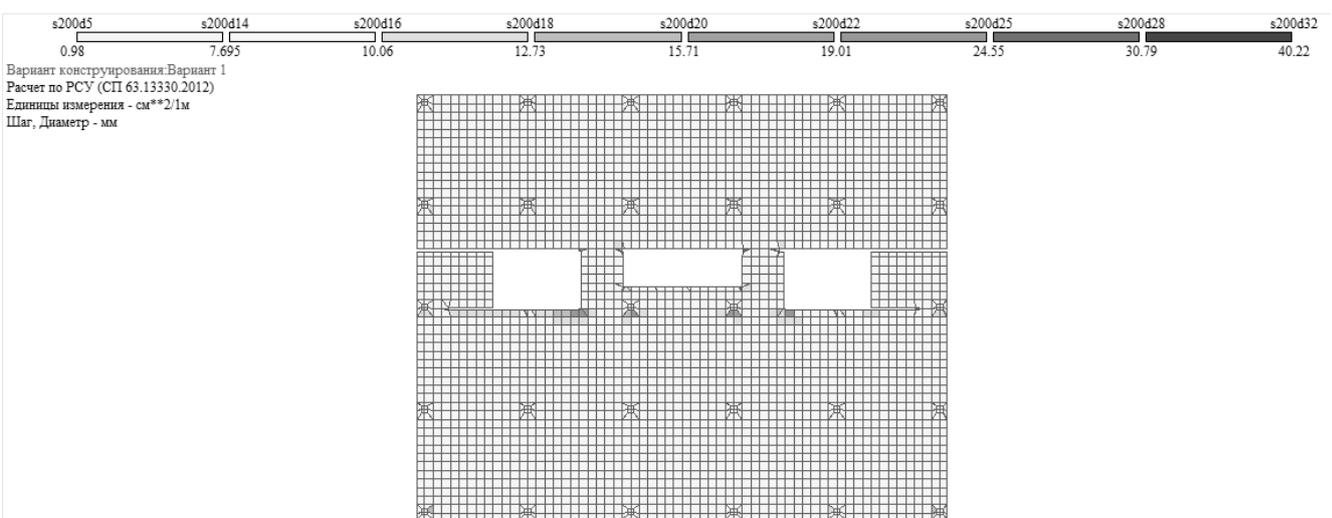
Верхнее армирование плиты перекрытия по оси Y
